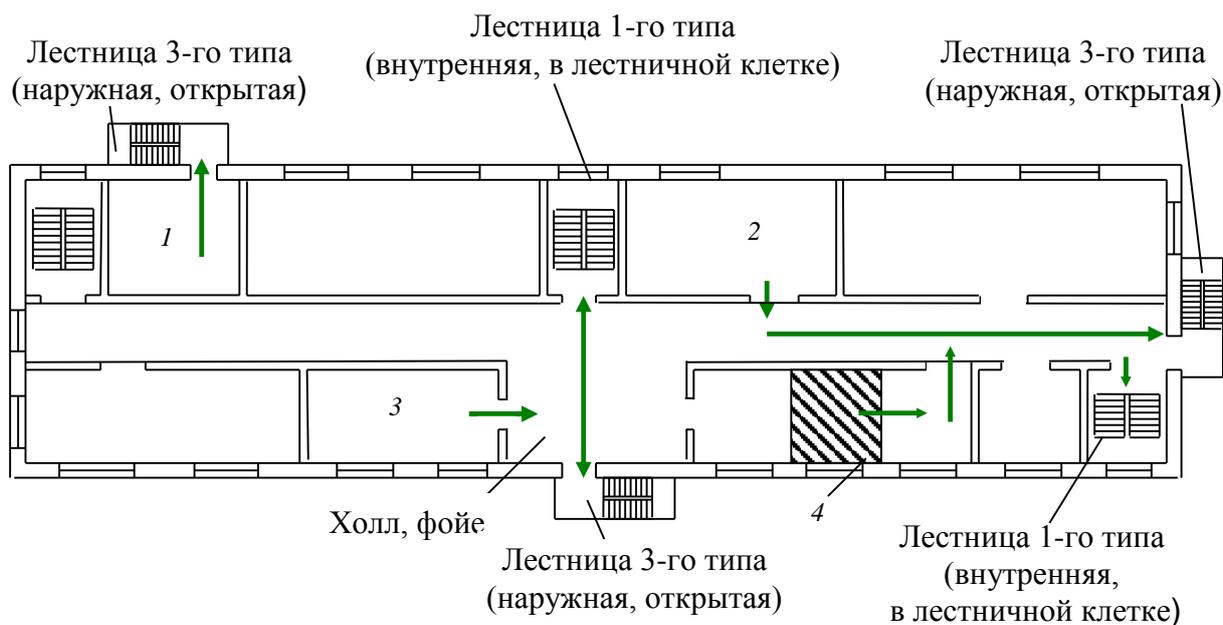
, б. Эвакуационные выходы из помещений, расположенных на любых этажах, кроме первого.
